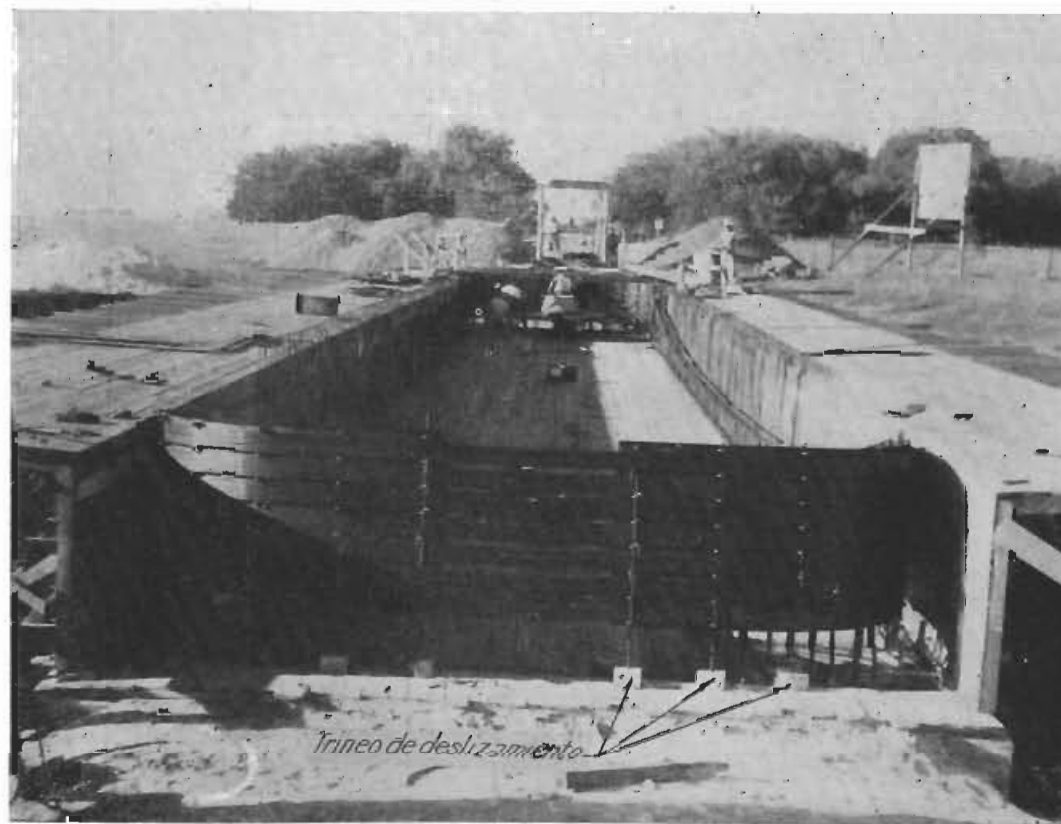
Se observa el encofrado armado del puente, sin block de tesado
